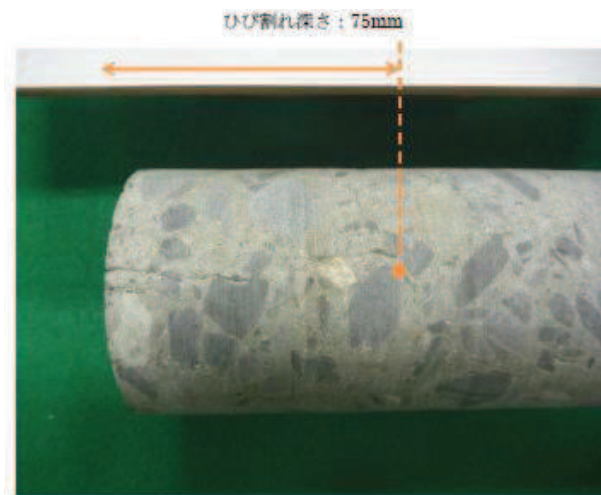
ひび割れ箇所から採取したコンクリートコアの例（採取位置：④）
